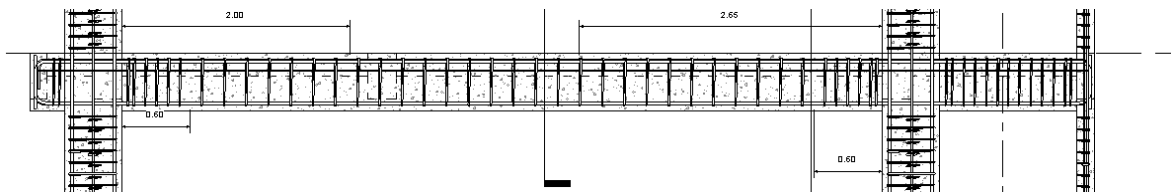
Vista Corte de distribución de acero en Viga VP-100 (Fuente: Elaboración Propia).
